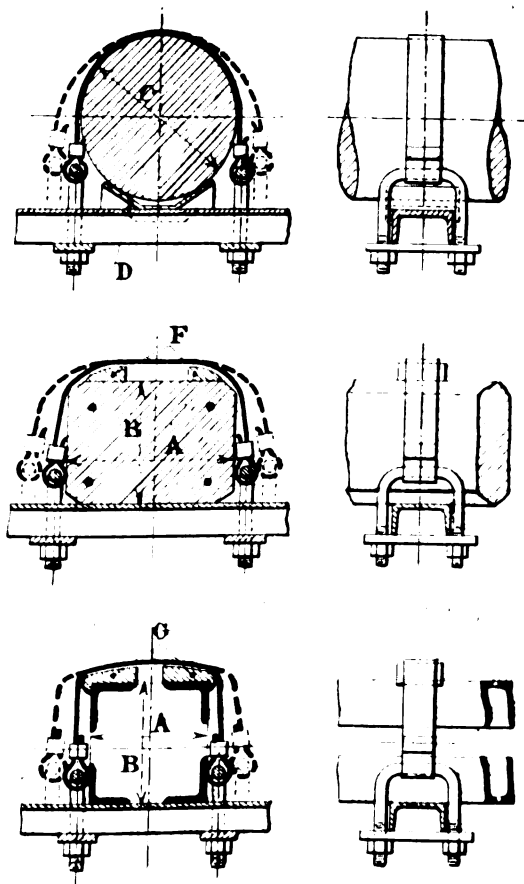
Schémas d'assemblage de traverses sur poteaux. (Matériel Mahaut).
